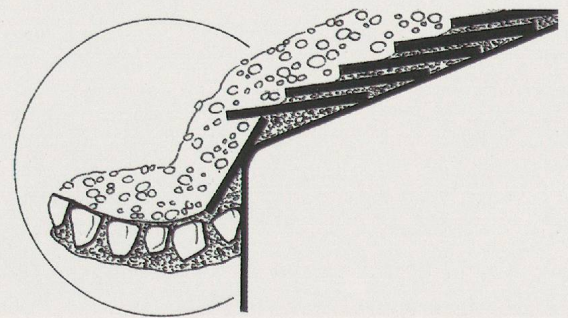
Coupe de la serre souterraine avec sa couverture en tuile recouverte de gravier sec drainant les eaux dans les rigoles d'écoulement (éch. 1:100). A droite, détail de la pose du dernier rang de tuile et de la rigole d'écoulement.
